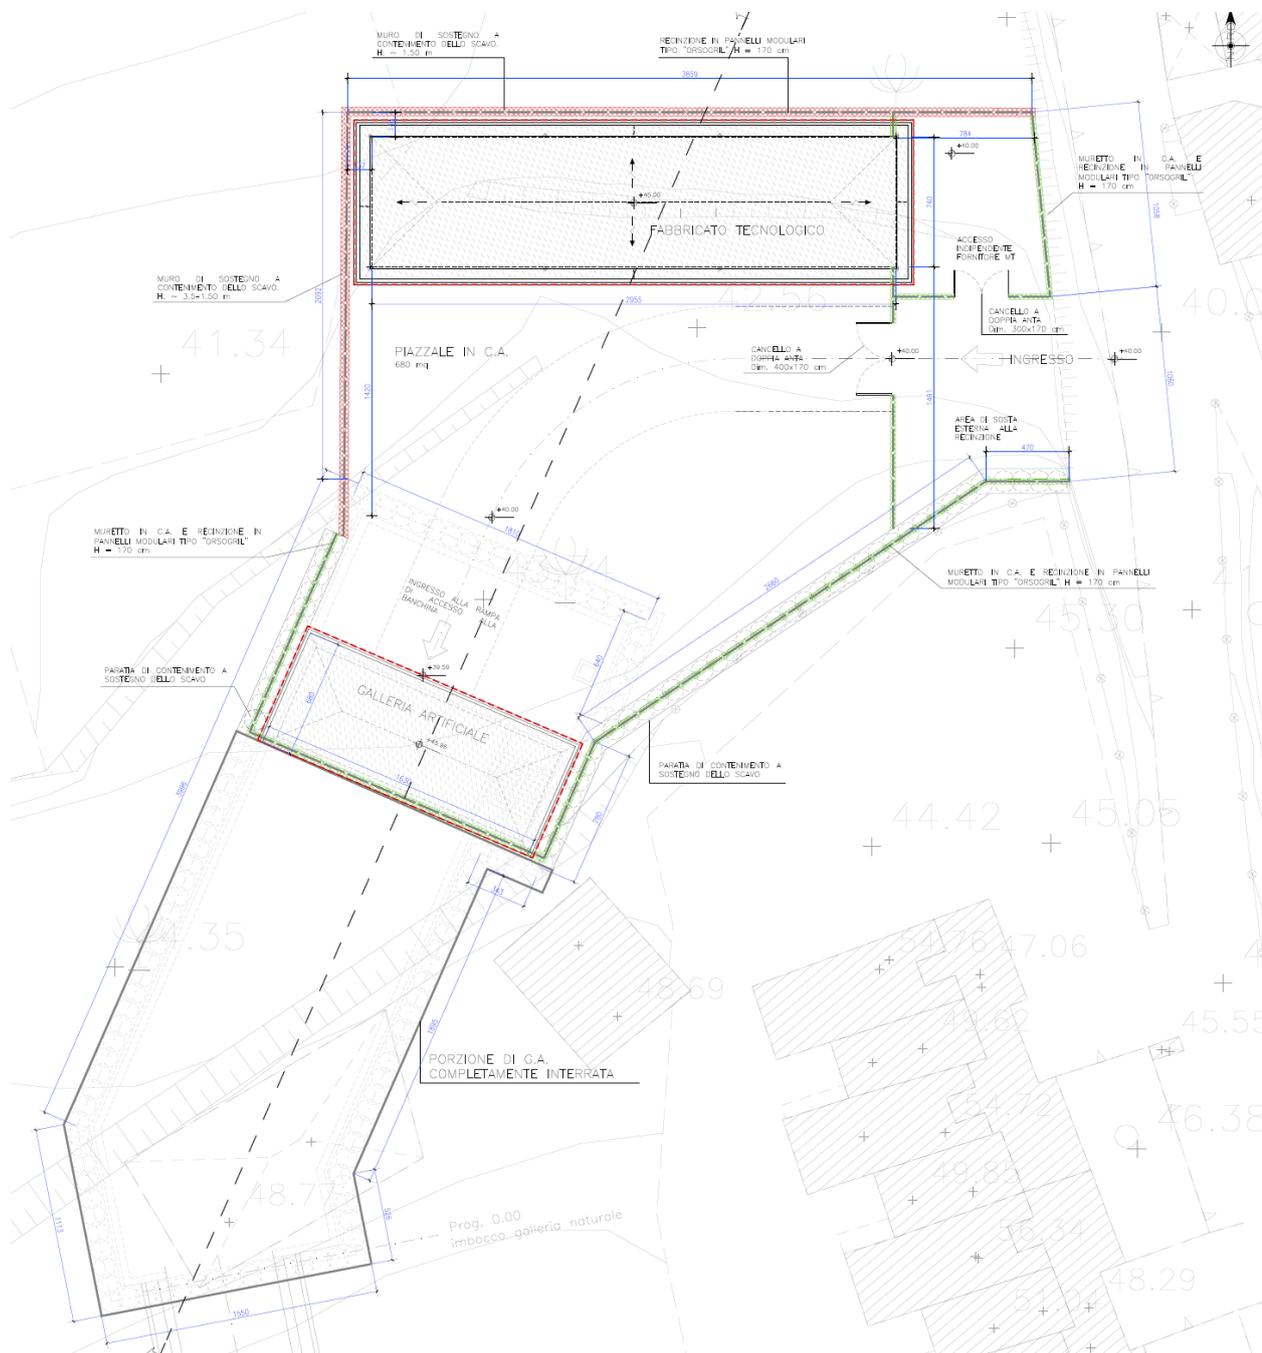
Sistemazione definitiva dell'area di accesso alla galleria di sfollamento
